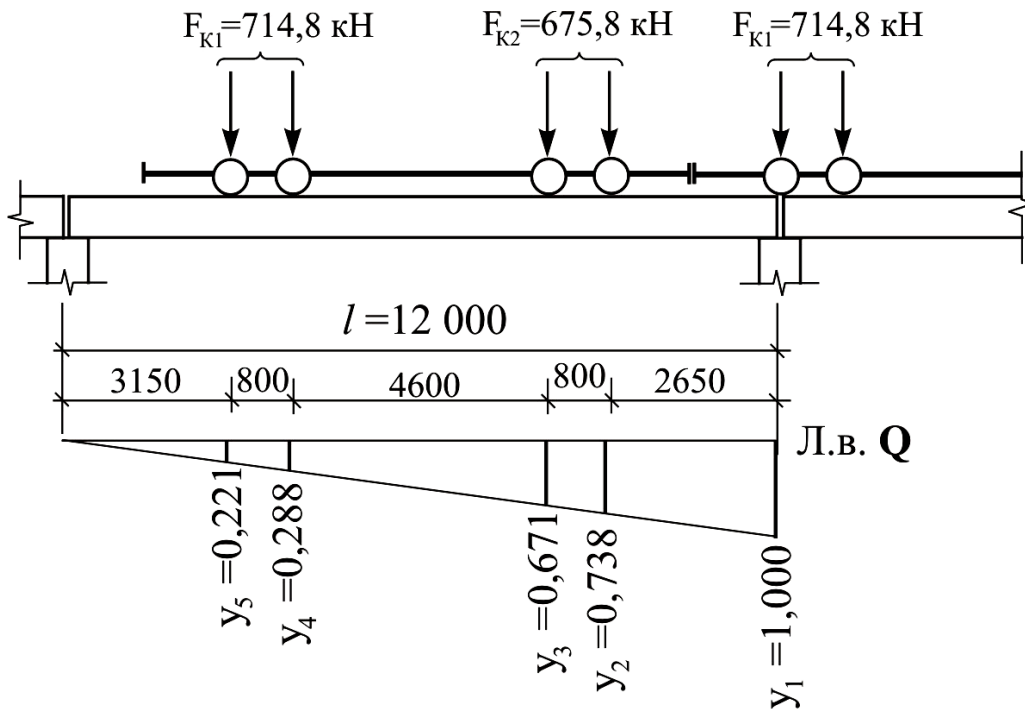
К определению расчетных поперечных сил в подкрановой балке
